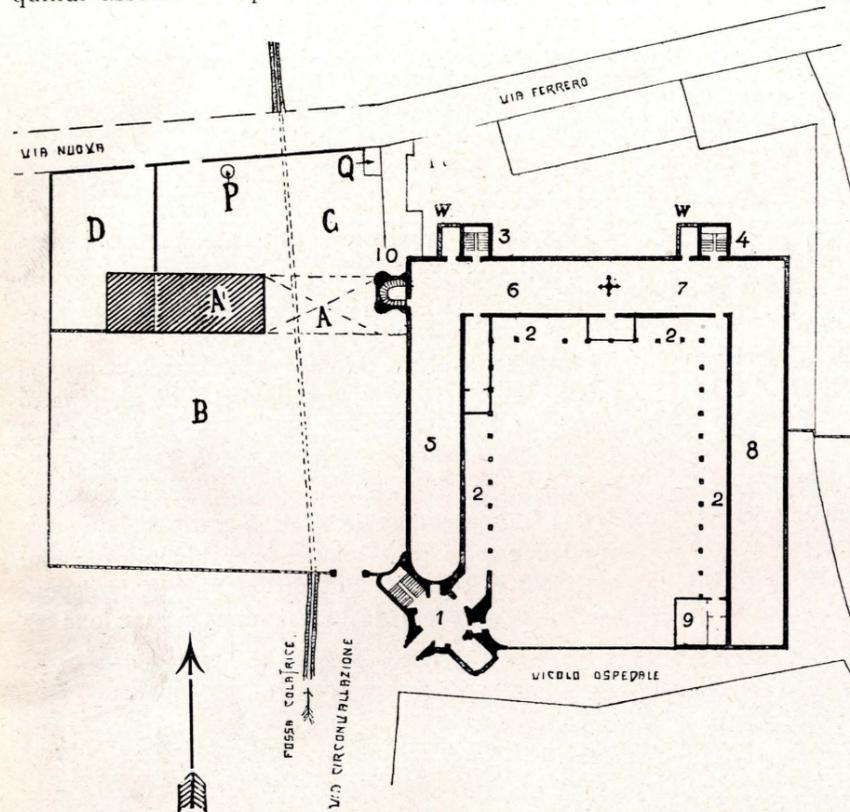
Schizzo planimetrico (Scala 1:1000).
